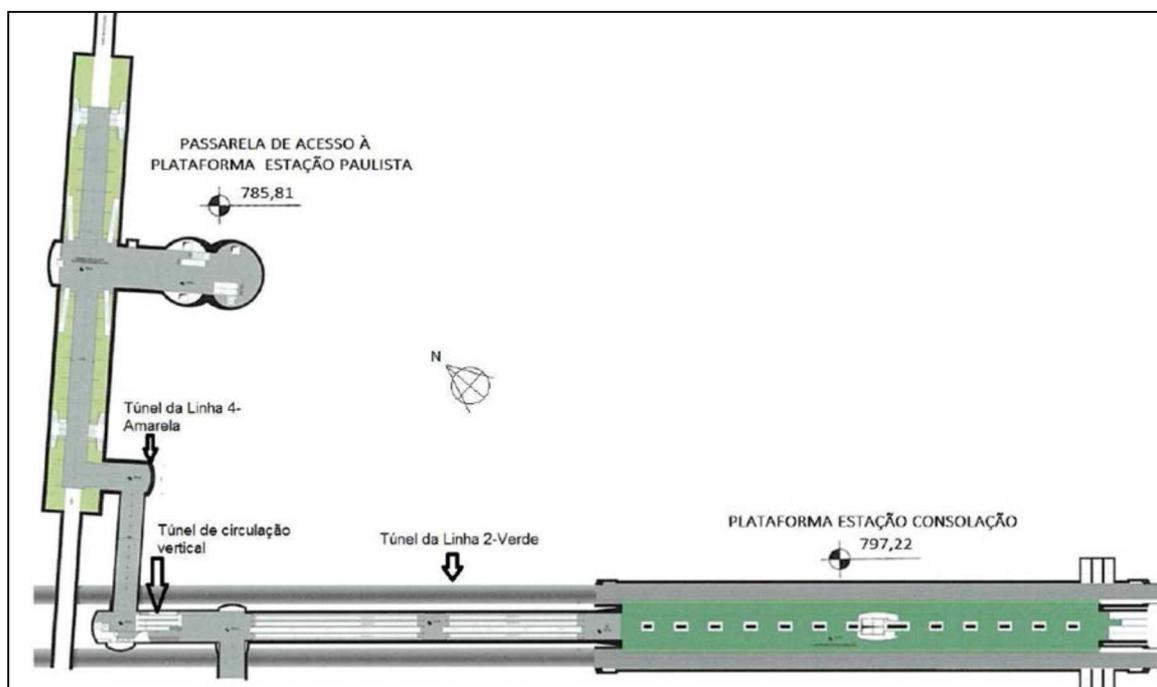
Ligação existente entre as Estações Consolação e Paulista (Fonte: RAP).
